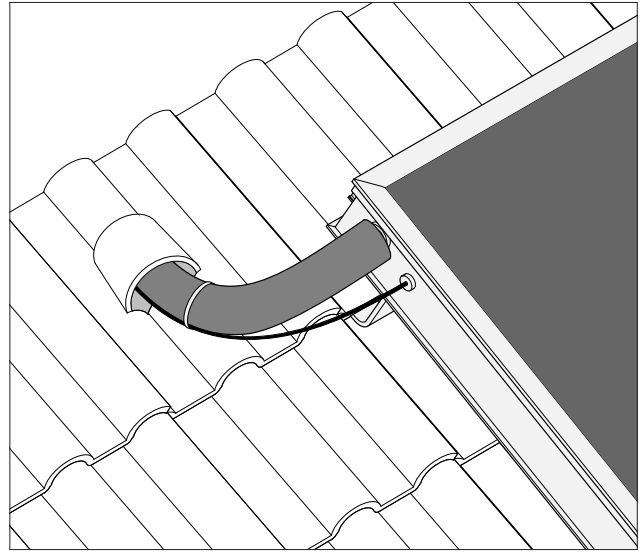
Fühlerkabel mit Kabelbinder an Anschluss-schlauch befesti-gen.
